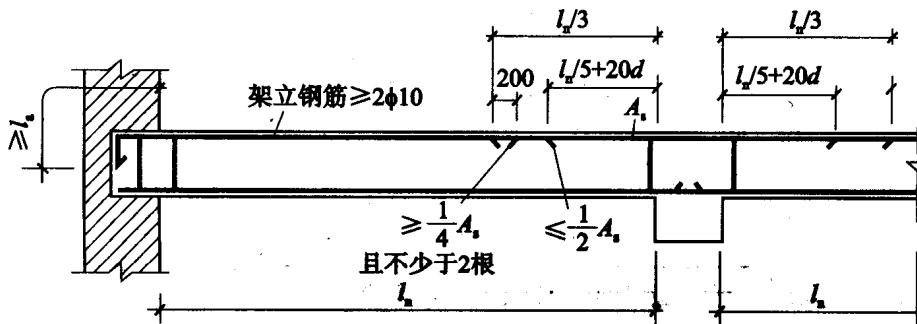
无弯起钢筋等跨次梁的典型钢筋布置图
